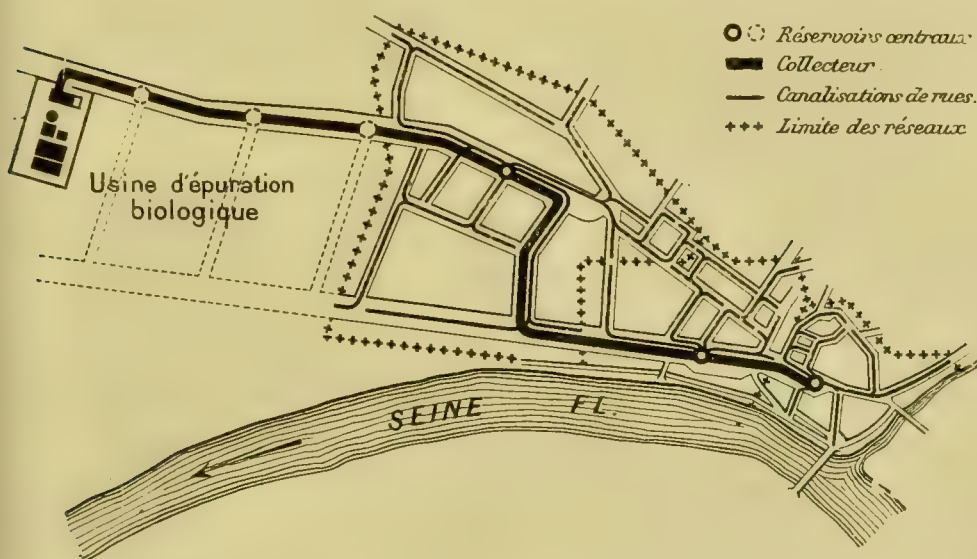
Plan général d'assainissement de Villeneuve-Saint-Georges.
